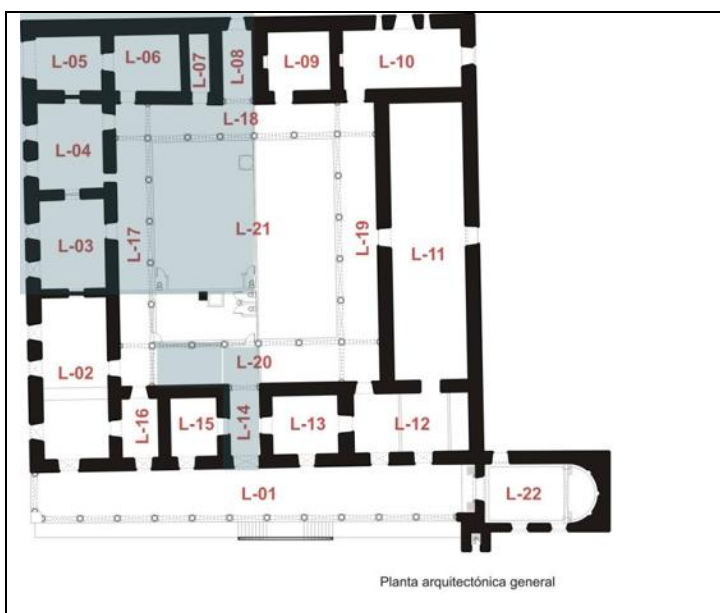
Planta general de la casa grande L. Plancarte dentro del casco de la ex hacienda la Saucedá,
